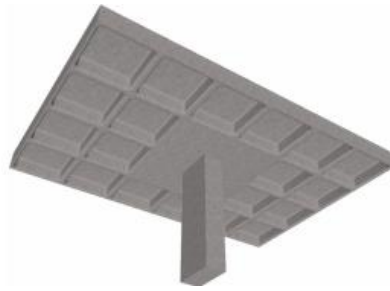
Maciçamente da laje fungiforme aligeirada junto ao apoio.
